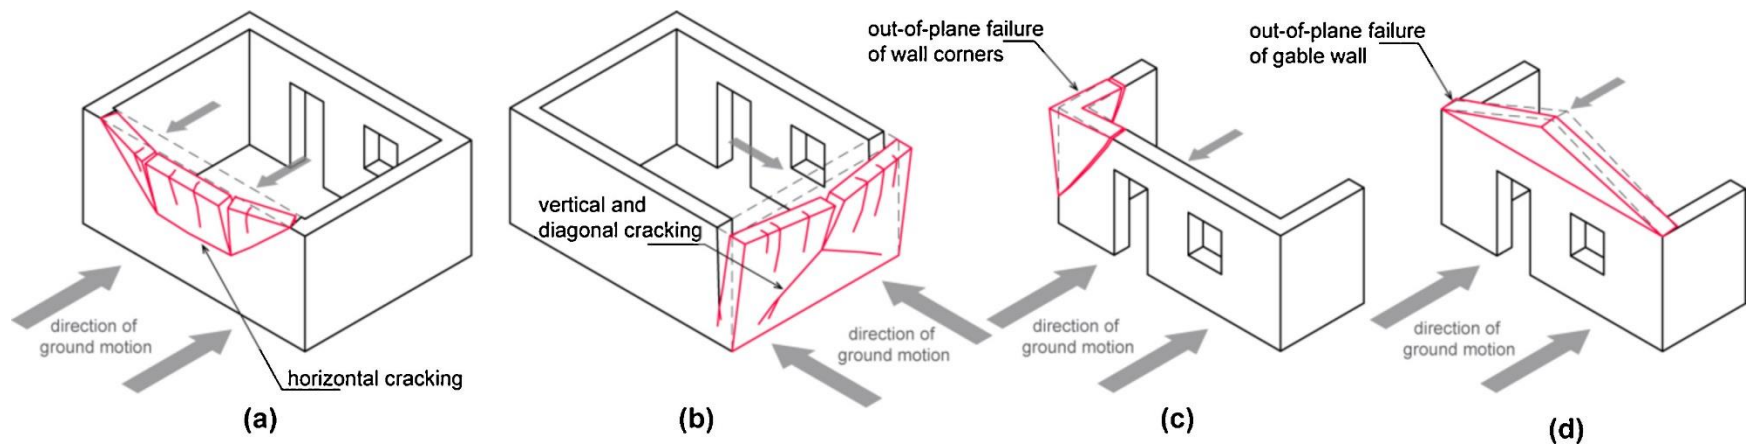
Mecanismo fuera del plano en paredes largas; (b) mecanismo fuera del plano en paredes cortas; (c) colapso fuera del plano de la esquina; y (d) colapso fuera del plano del tímpano. Fuente: Paulo B. Lourenço.
